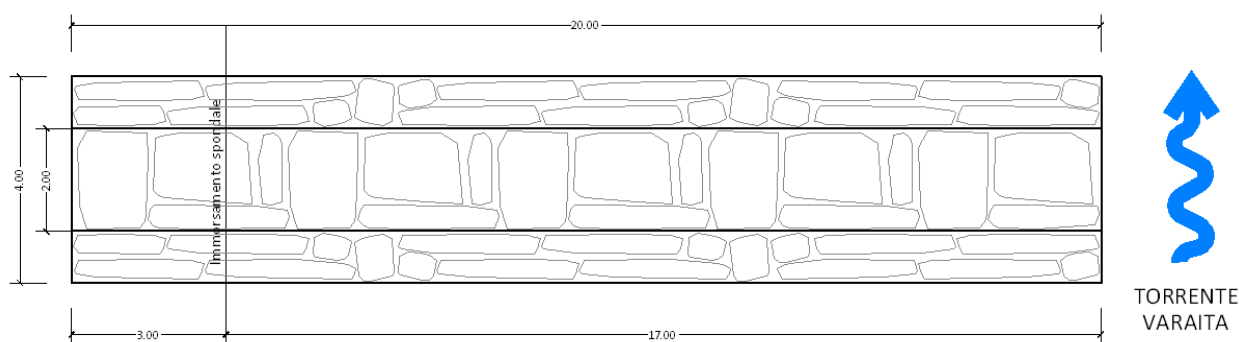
Tipologia 1 - Pianta tipo dei repellenti in massi di cava non cementati
